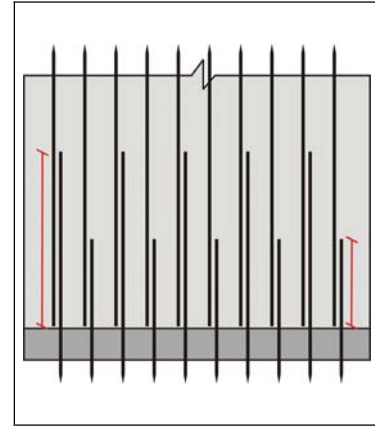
Caso Particular de Traslape Alternado Visto en Obra
